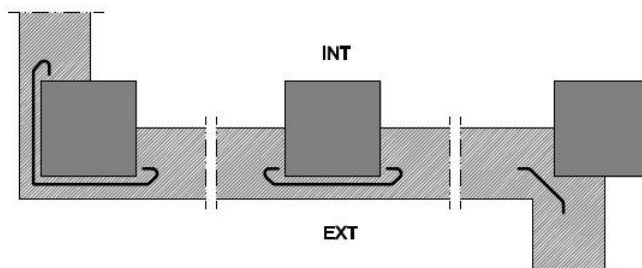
Ejemplo de encuentro de la fachada con los pilares
